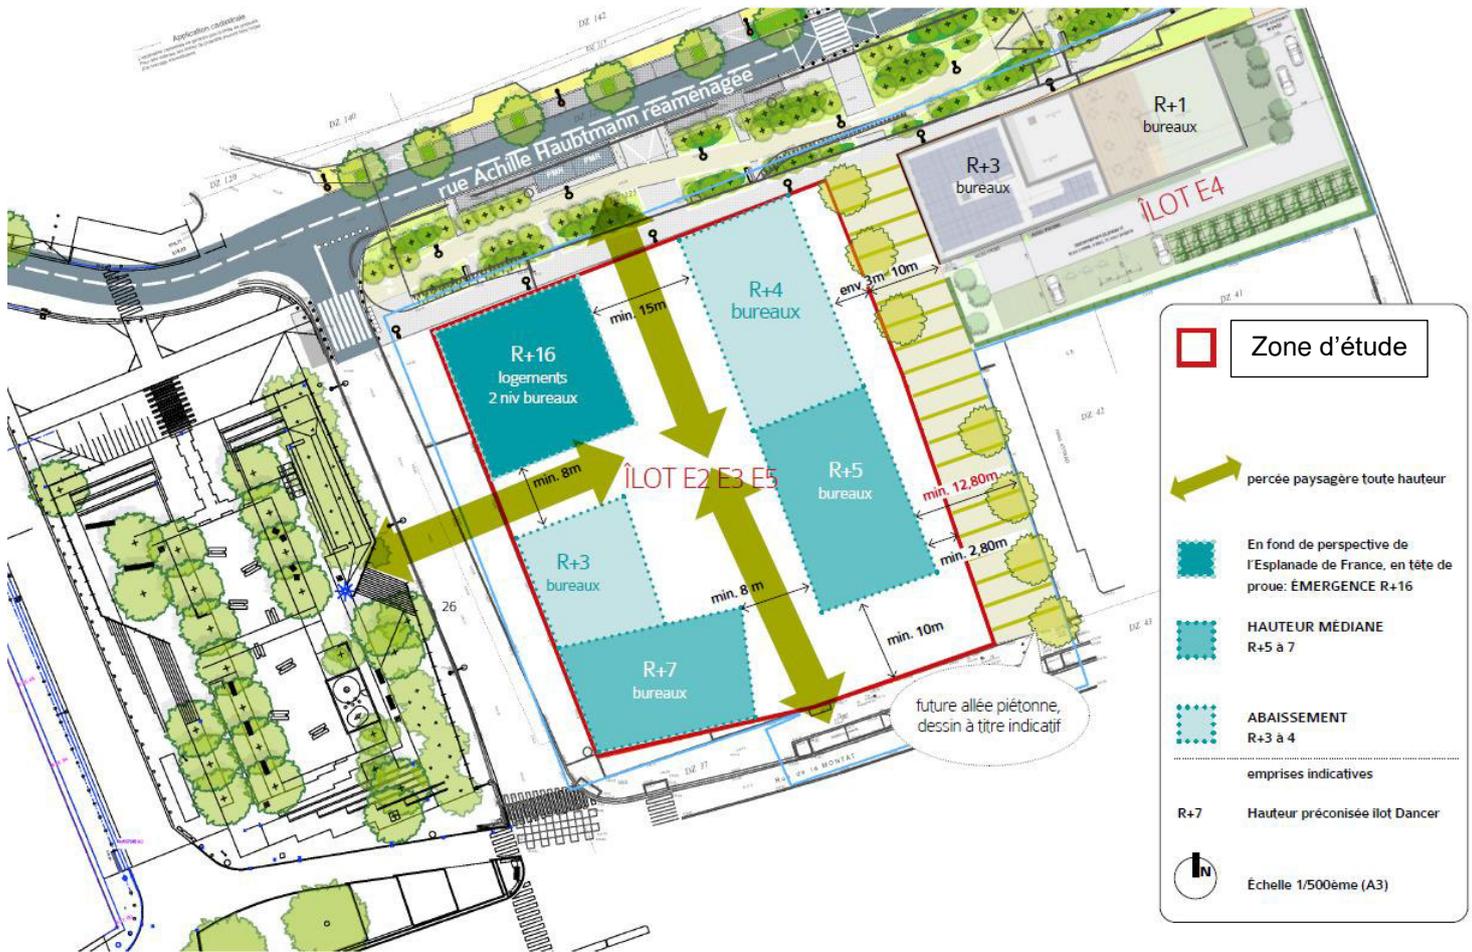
Organisation spatiale projetée et plan de masse du site (source : EPASE, avril 2022)
